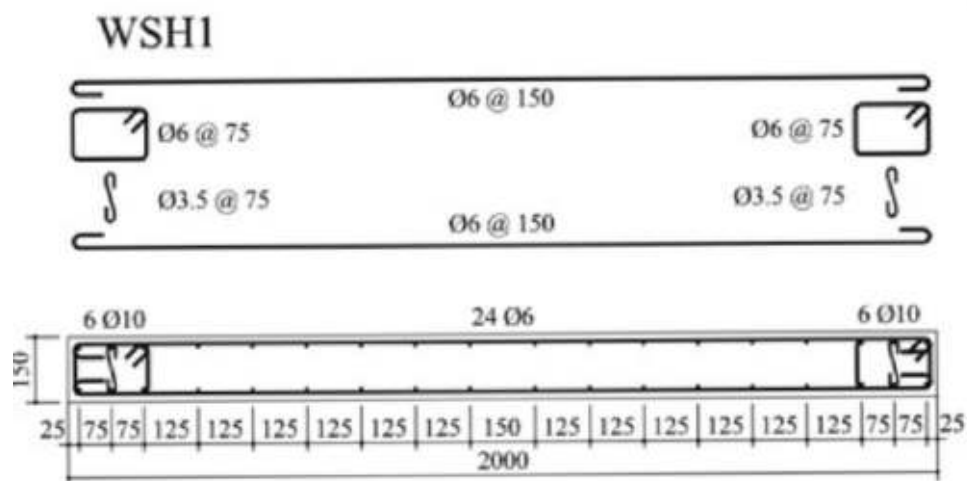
Acero de refuerzo del muro WSH1. Tomado de (Dazio et al., 1999)
